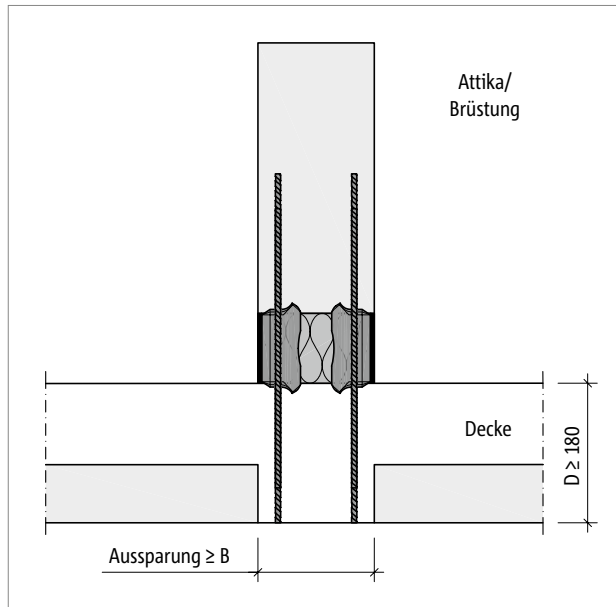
Schöck Isokorb® CXT Typ AP: Schnitt; Mindestabmessung Aussparung Elementplatte
